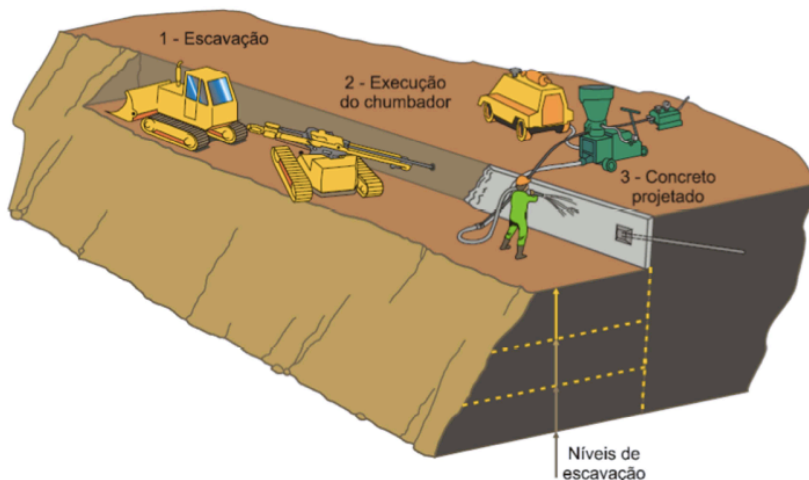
Construção de estrutura em solo grampeado em escavações com equipamentos mecânicos.
